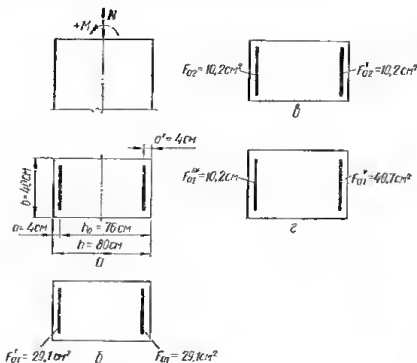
Внецентренно сжатый железобетонный элемент прямоугольного сечения с несимметричной арматурой: а — схемы усилий и поперечного сечения элемента; б и в — сечения арматуры, подобранные для первой и второй комбинаций усилий; е — принятое сечение арматуры.
